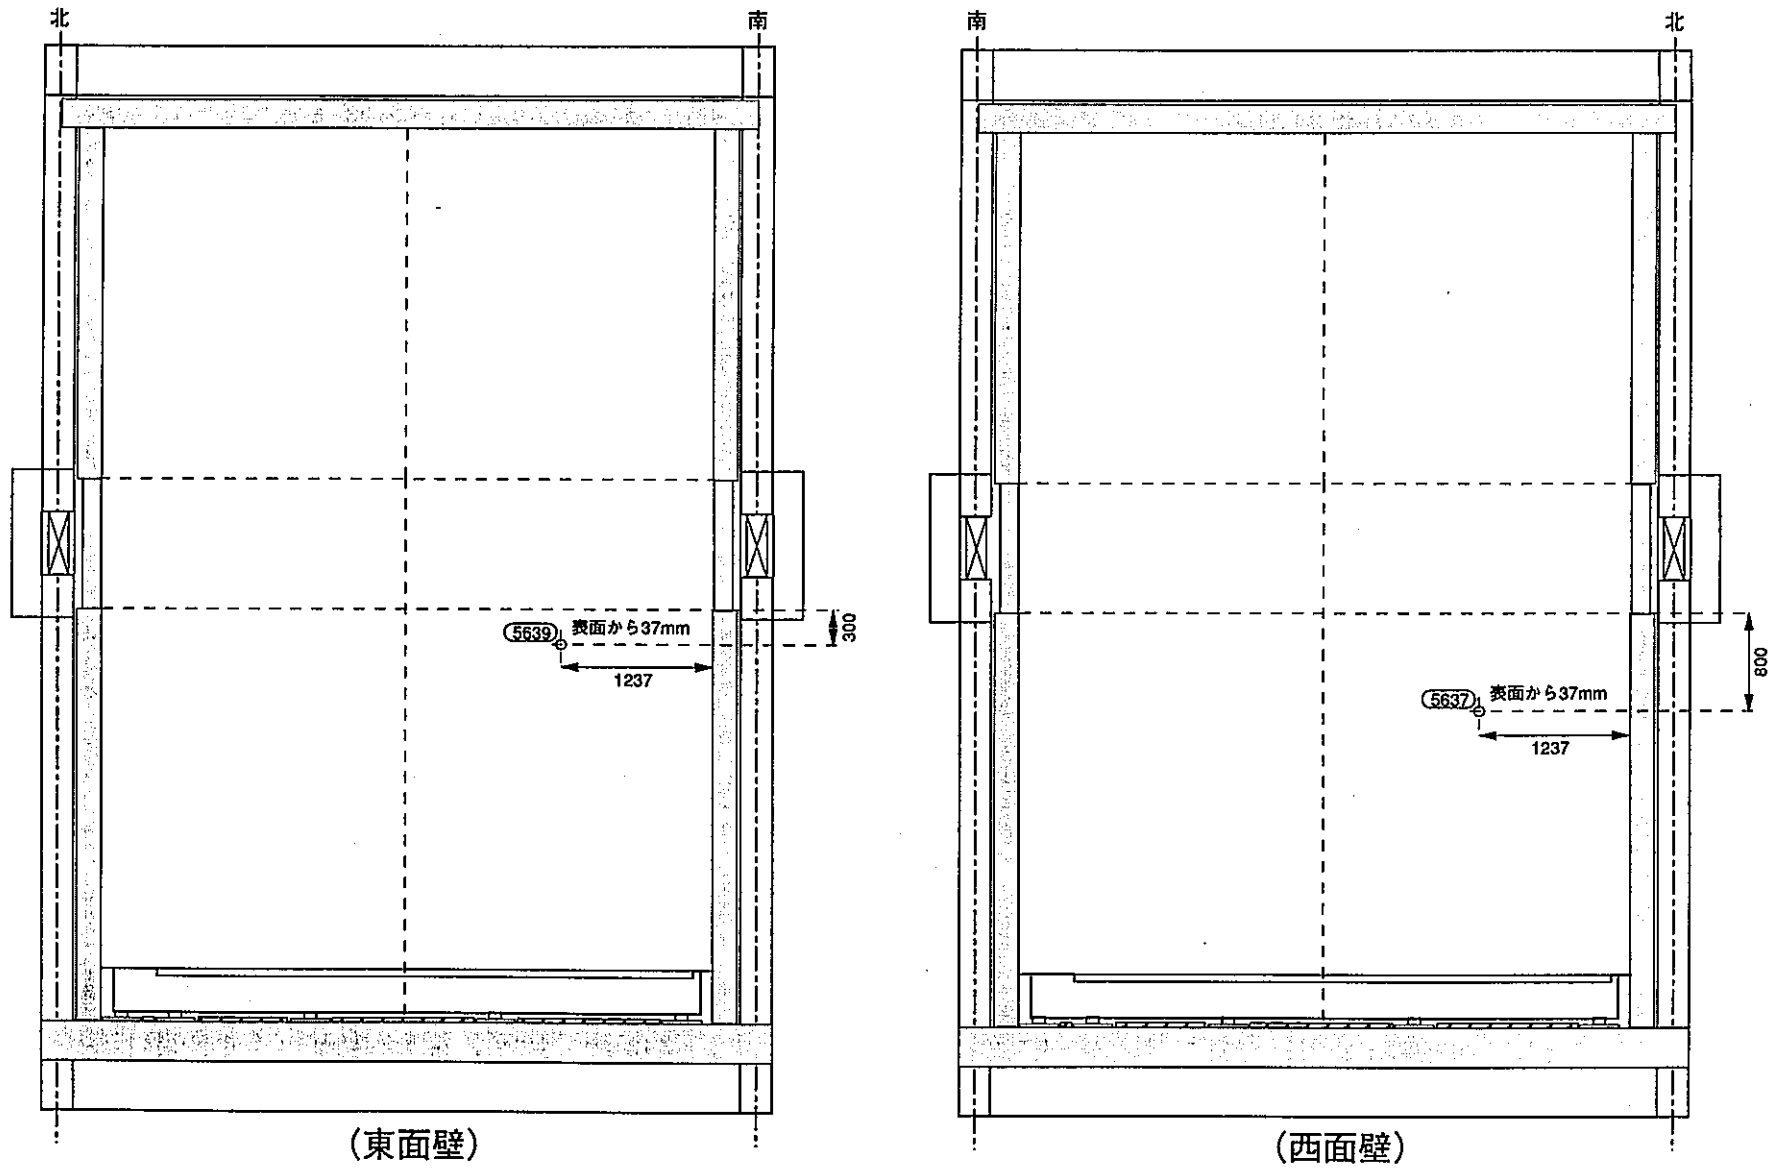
コンクリート熱電対配置図(3) (TE5637,5639)
